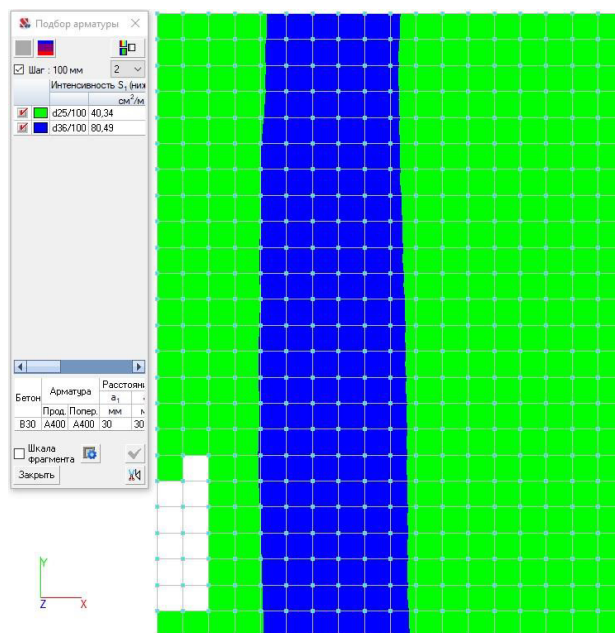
Интенсивность нижнего армирования фундаментной плиты по ОХ
